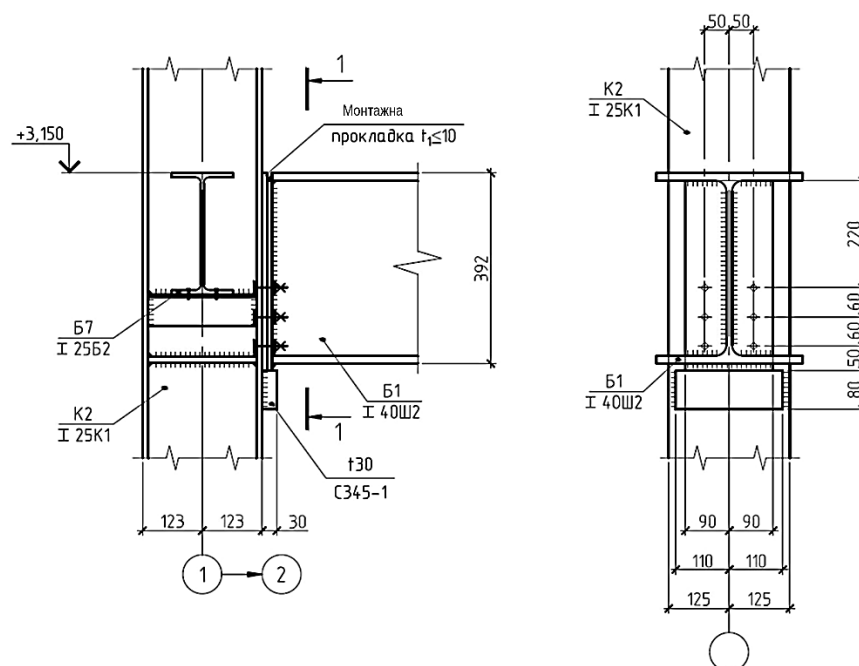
Вузол приєднання балки Б1 до колони збоку
